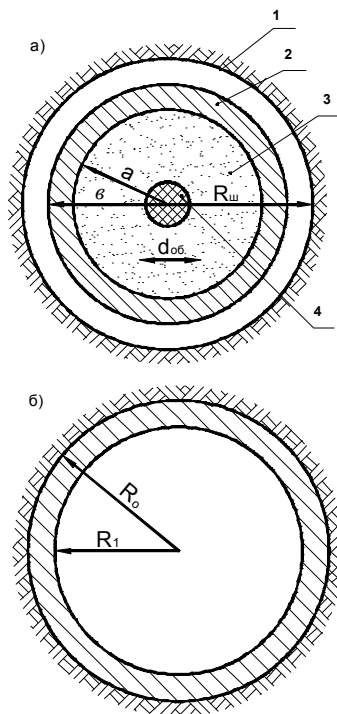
Расчетная схема динамического деформирования заготовки трубчатого анкера (положение заготовки до взрыва (а), после взрыва (б): 1 – шнур; 2 – заготовка; 3 – наполнитель; 4 – заряд ВВ
